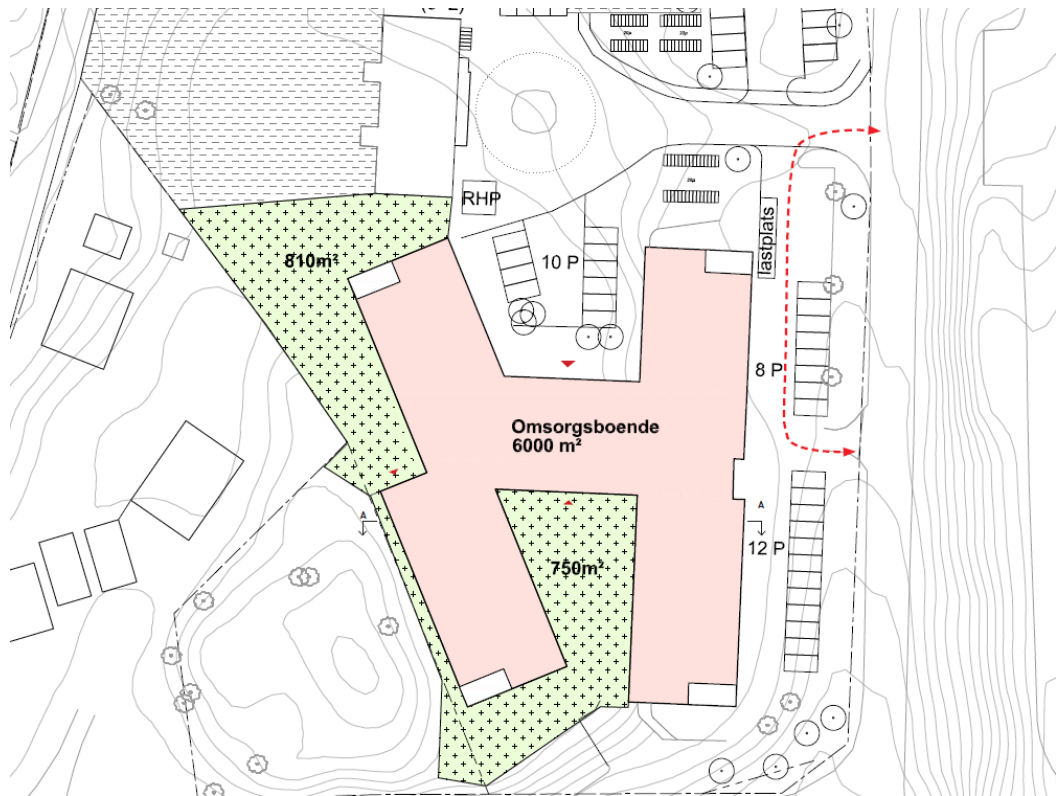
Möjlig utformning och placering av nytt omvårdnadsboende. Illustrationen visar ett helt våningsplan.
